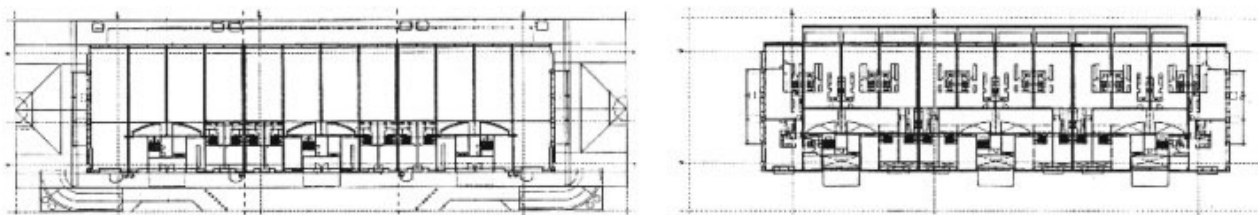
planta térreo e 1º pavimento do Galpão 8. Fonte: Revista Arquis nº 1.
